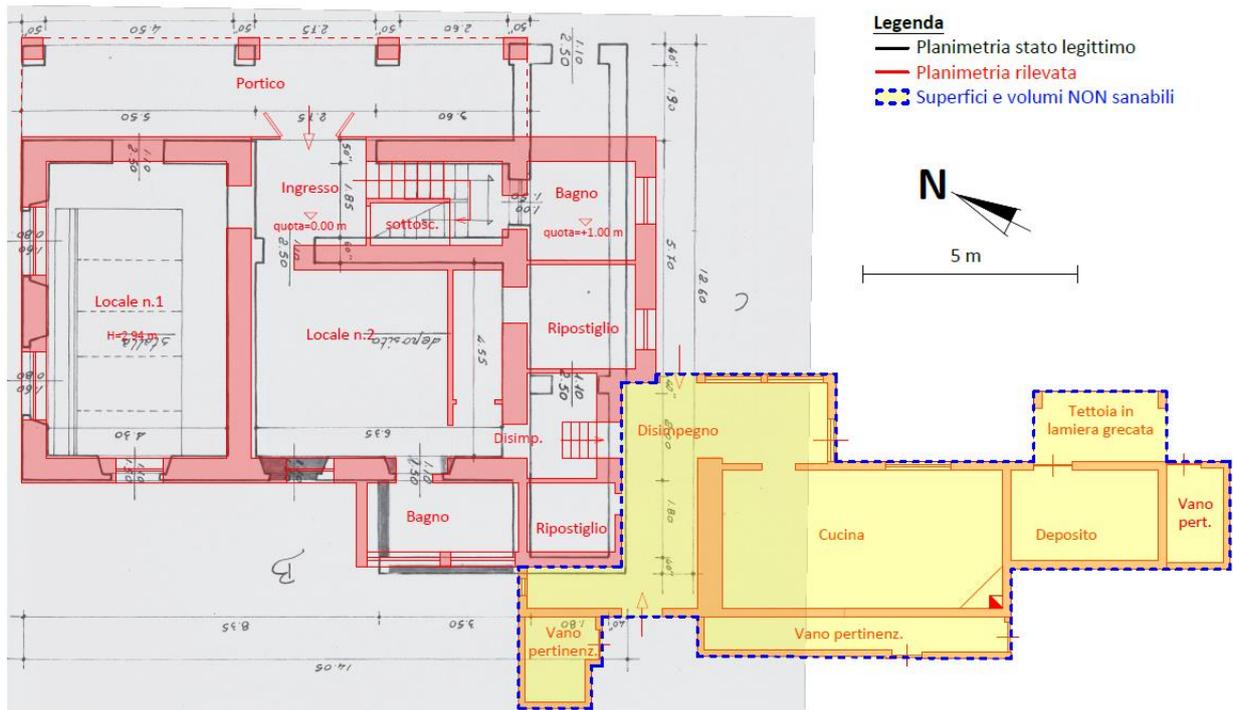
Sovrapposizione stato reale dei luoghi e progetto autorizzato – Planimetria piano terra del fabbricato principale (F. 20 p.IIa 202)
